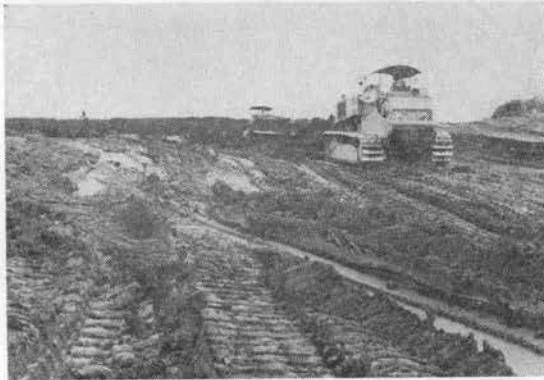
スクレードドーザ SR-40(4m³) の掘削状況
